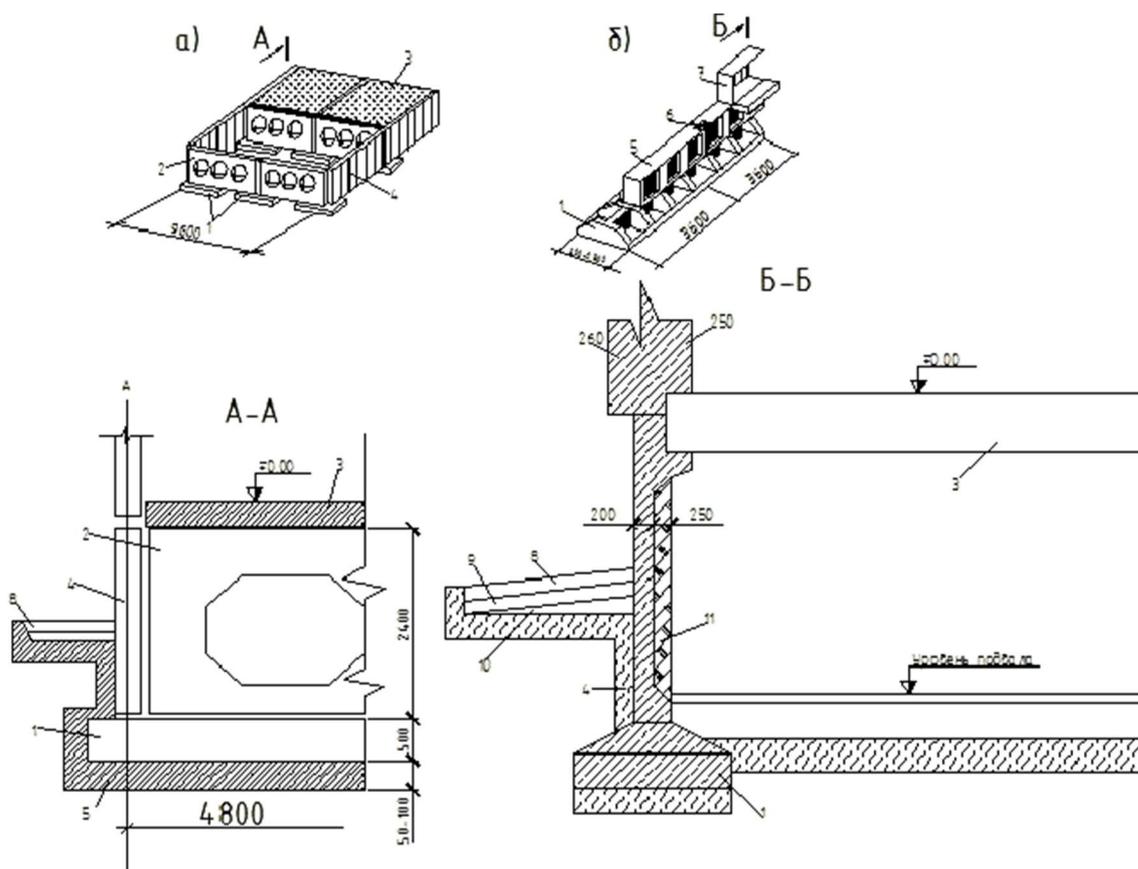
Конструкции облегченных ленточных фундаментов:
